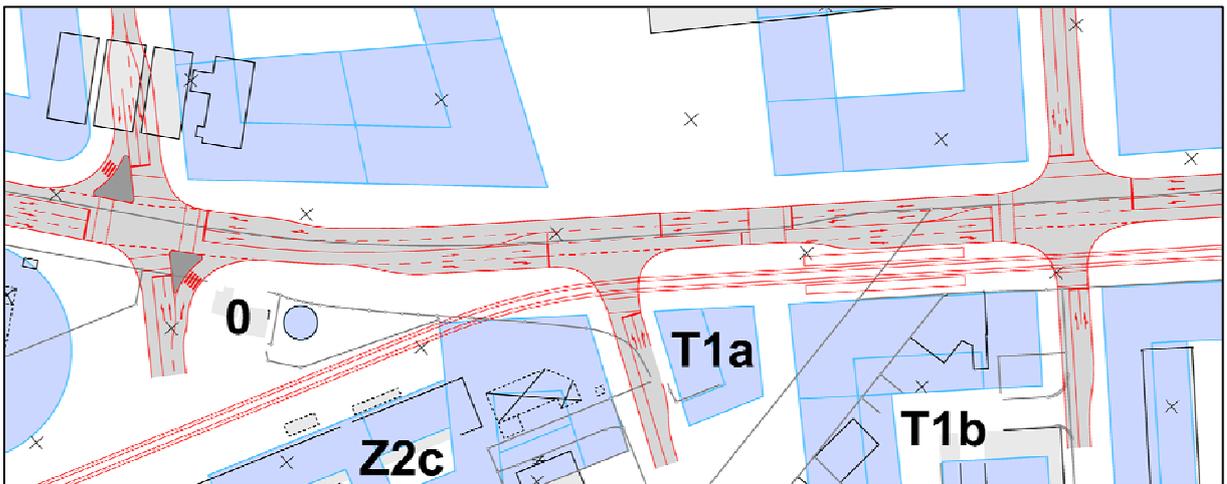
Lageplan Czernyring Bereich Mitte, Variante 2x1
